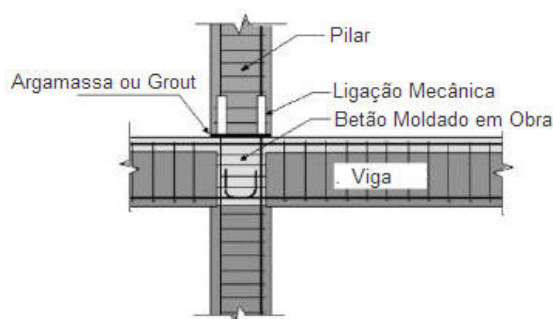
Ligação com betonagem em obra do nó viga - pilar (adaptada de [23])
